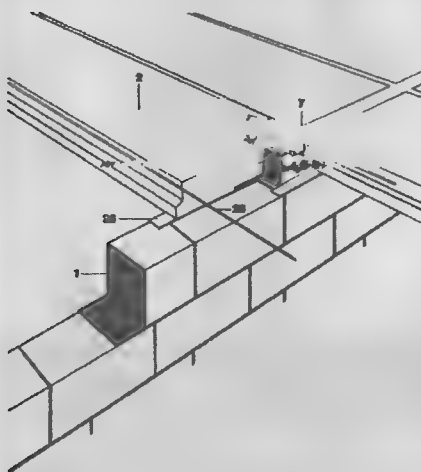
Опоры для панелей перекрытия, кольцевой анкер, панели перекрытия на несущей внутренней стене:
